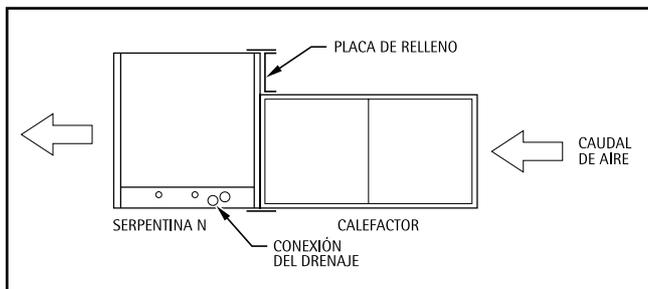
Instalación Horizontal-Izquierda con Placa de Relleno
